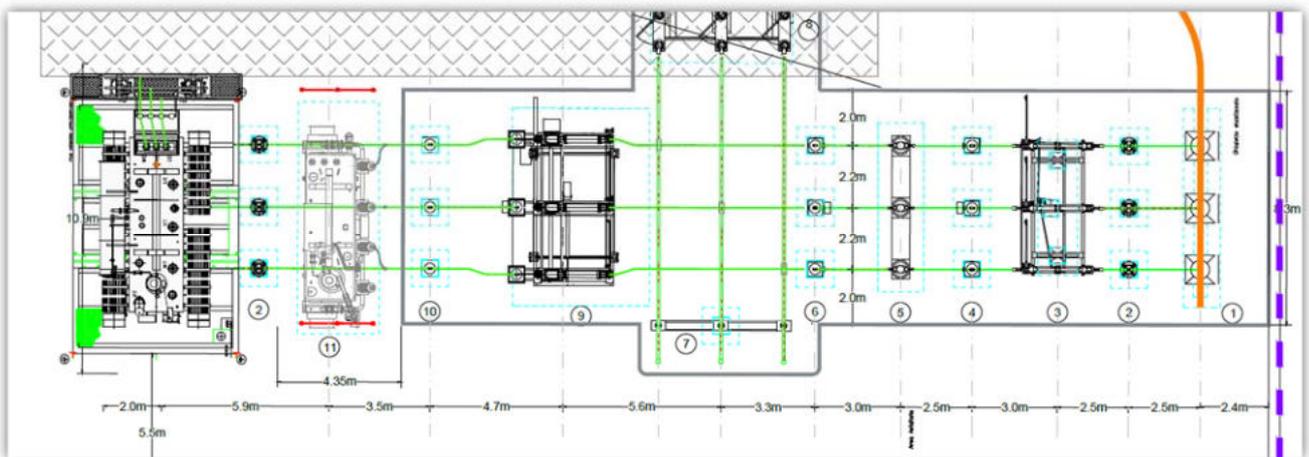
Planimetria elettromeccanica della SSE, con stralcio delle sbarre principali per la condivisione di Stallo con il futuro ampliamento.
